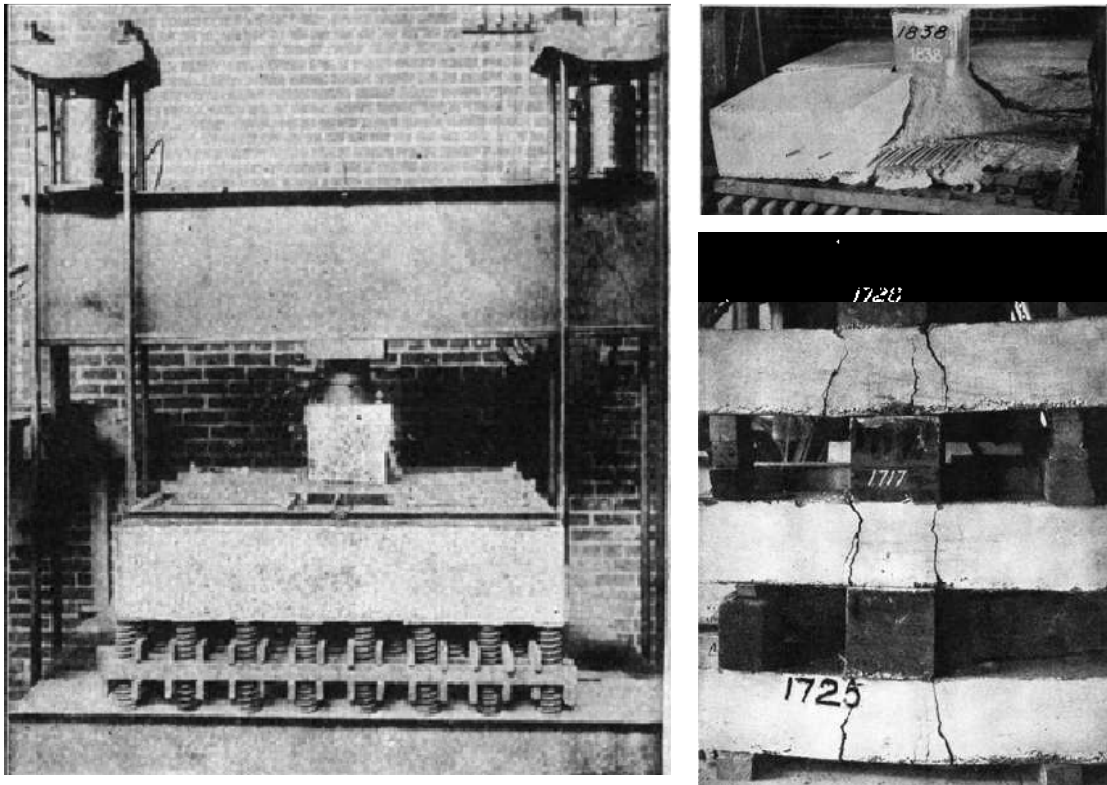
Ensaio em sapatas de concreto armado (TALBOT, 1913)
